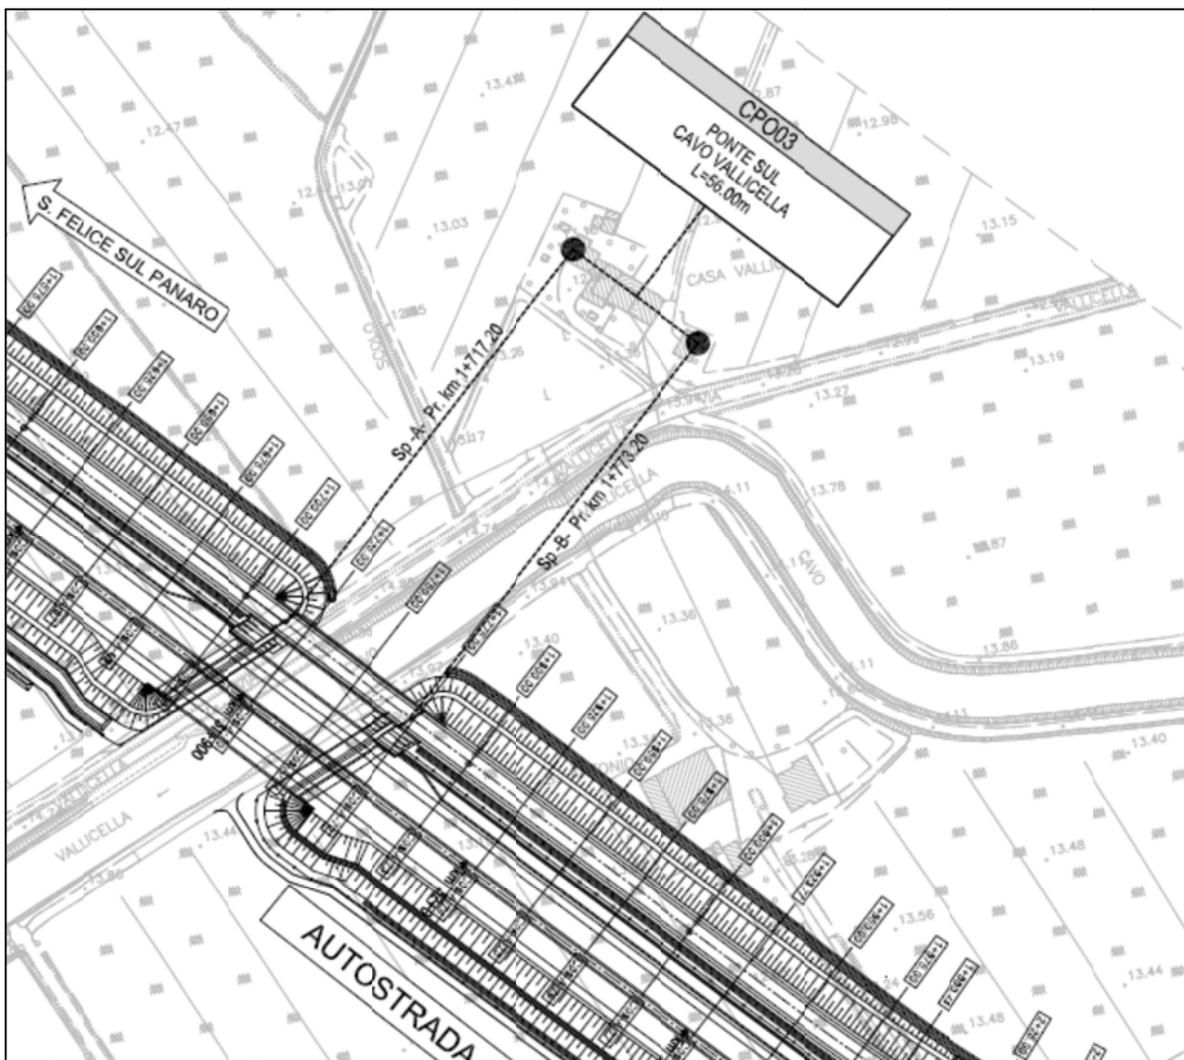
STRALCIO PLANIMETRICO PD
